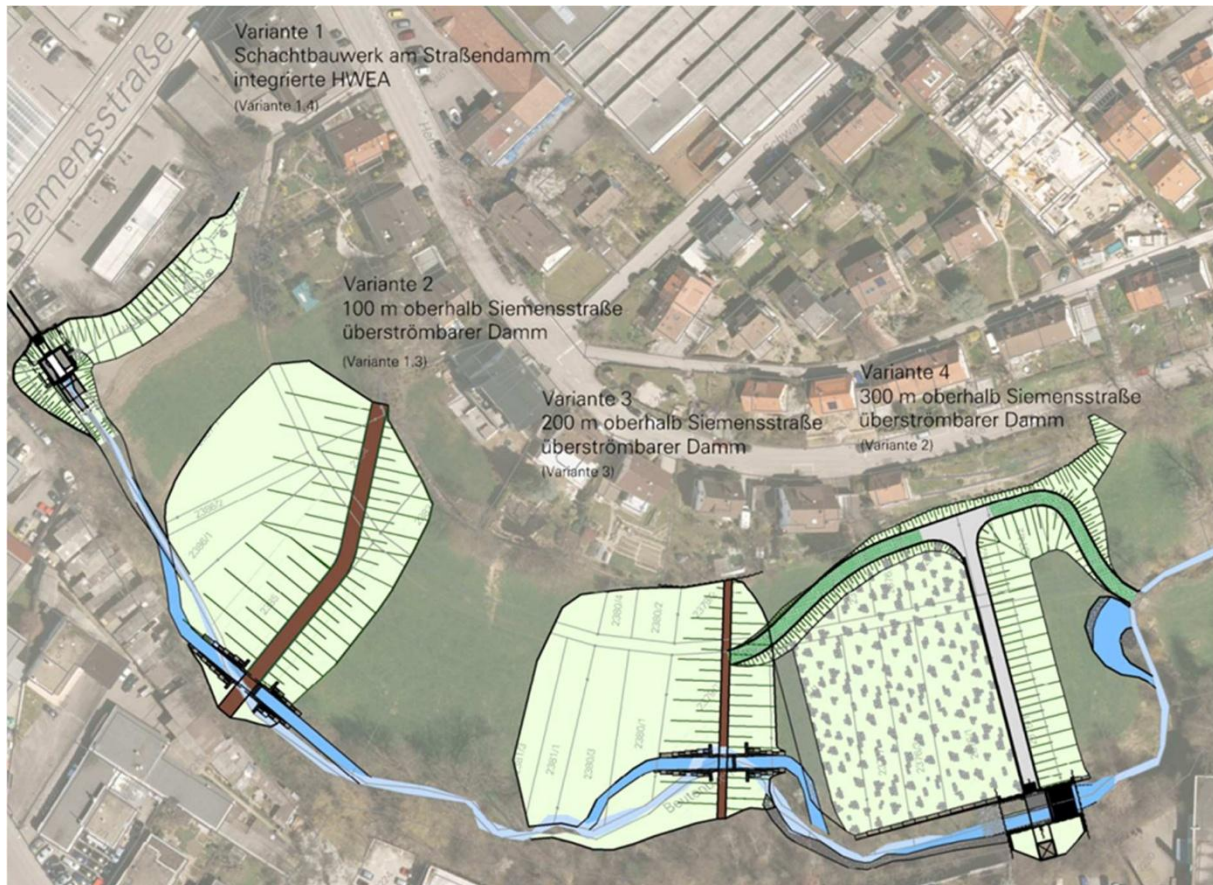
Lageplan mit den untersuchten Planungsvarianten Unteres Scheffzental
